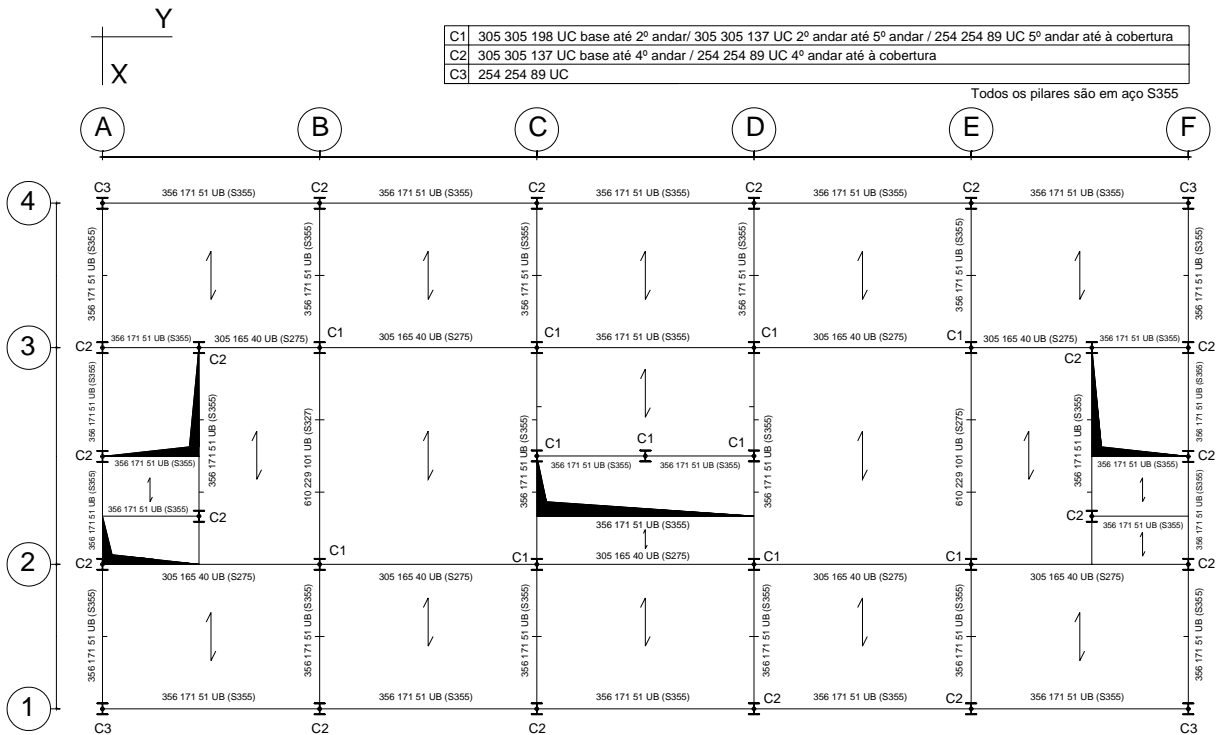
Planta de um piso intermédio do edifício de Cardington.
